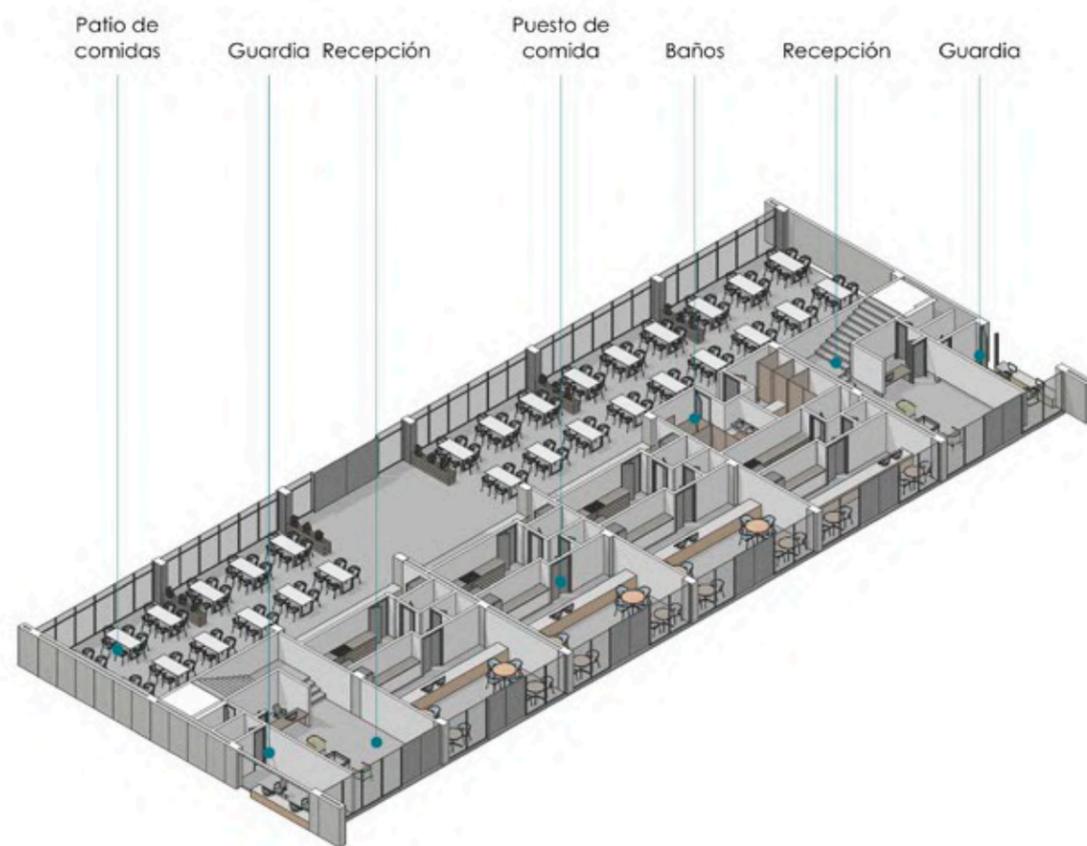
| Planta baja patio de comidas | Fuente: Elaboración Propia
